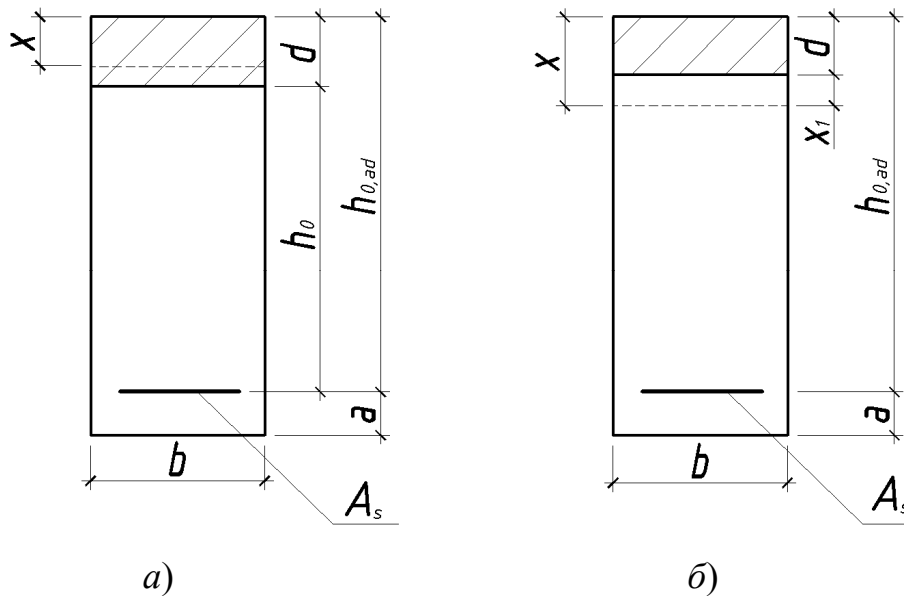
Розрахунковий переріз при підсиленні нарощуванням стиснутої зони:
